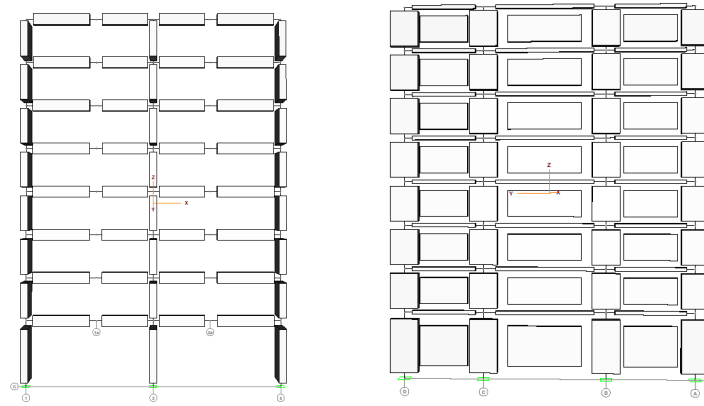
Vista de elevación: a) Longitudinal y b) Transversal
